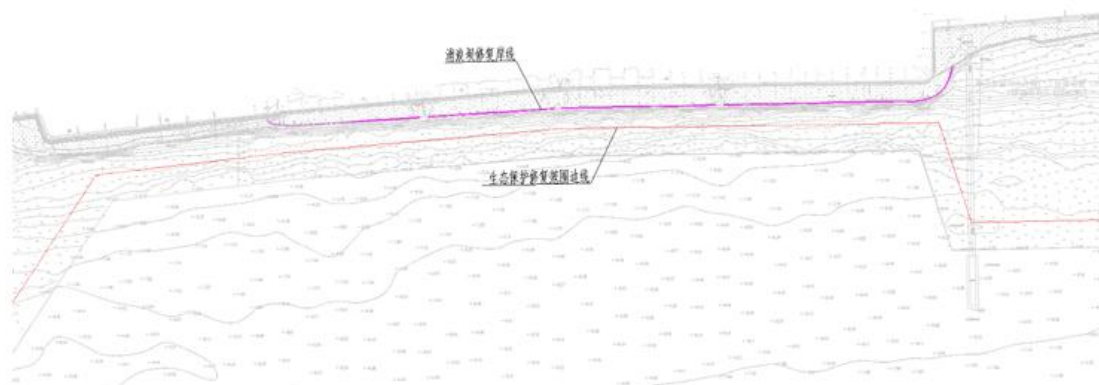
海水塘岸段原设计消浪坝修复平面图
